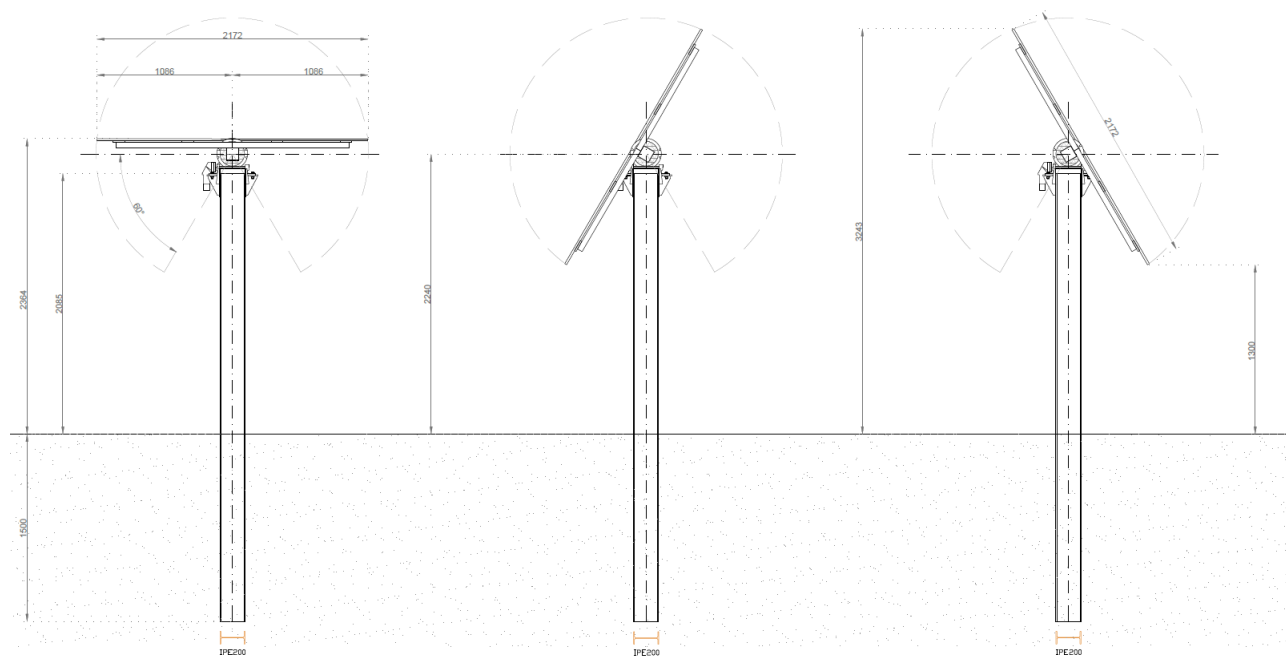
Layout dell'inseguitore SOLTEC, con pannelli montati perpendicolarmente all'asse di rotazione.
